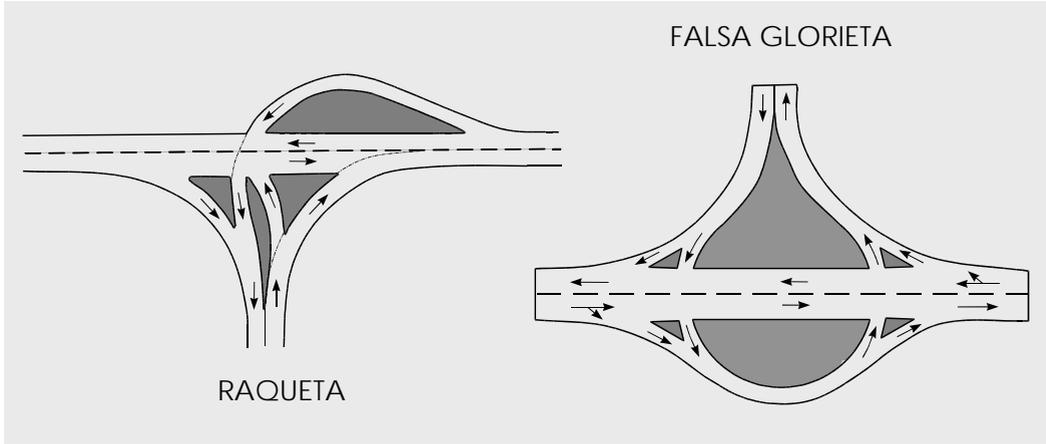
Variantes en raqueta y rotonda o falsa glorieta
